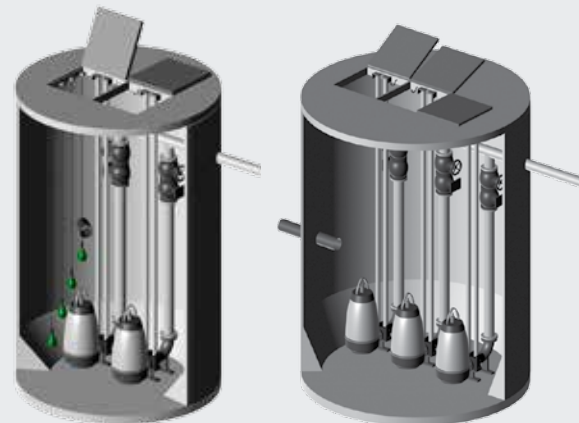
Installation mit zwei und drei Klärwasser-Tauchpumpen auf Kupplungsfußkrümmer mit Führungsrohren
